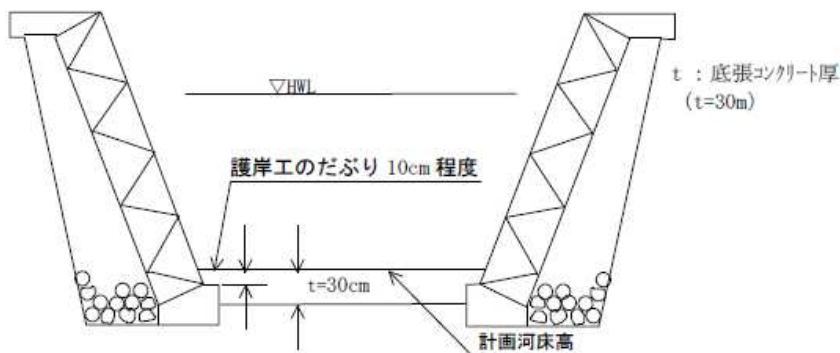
コンクリート張りの構造及び護岸の根入れ
